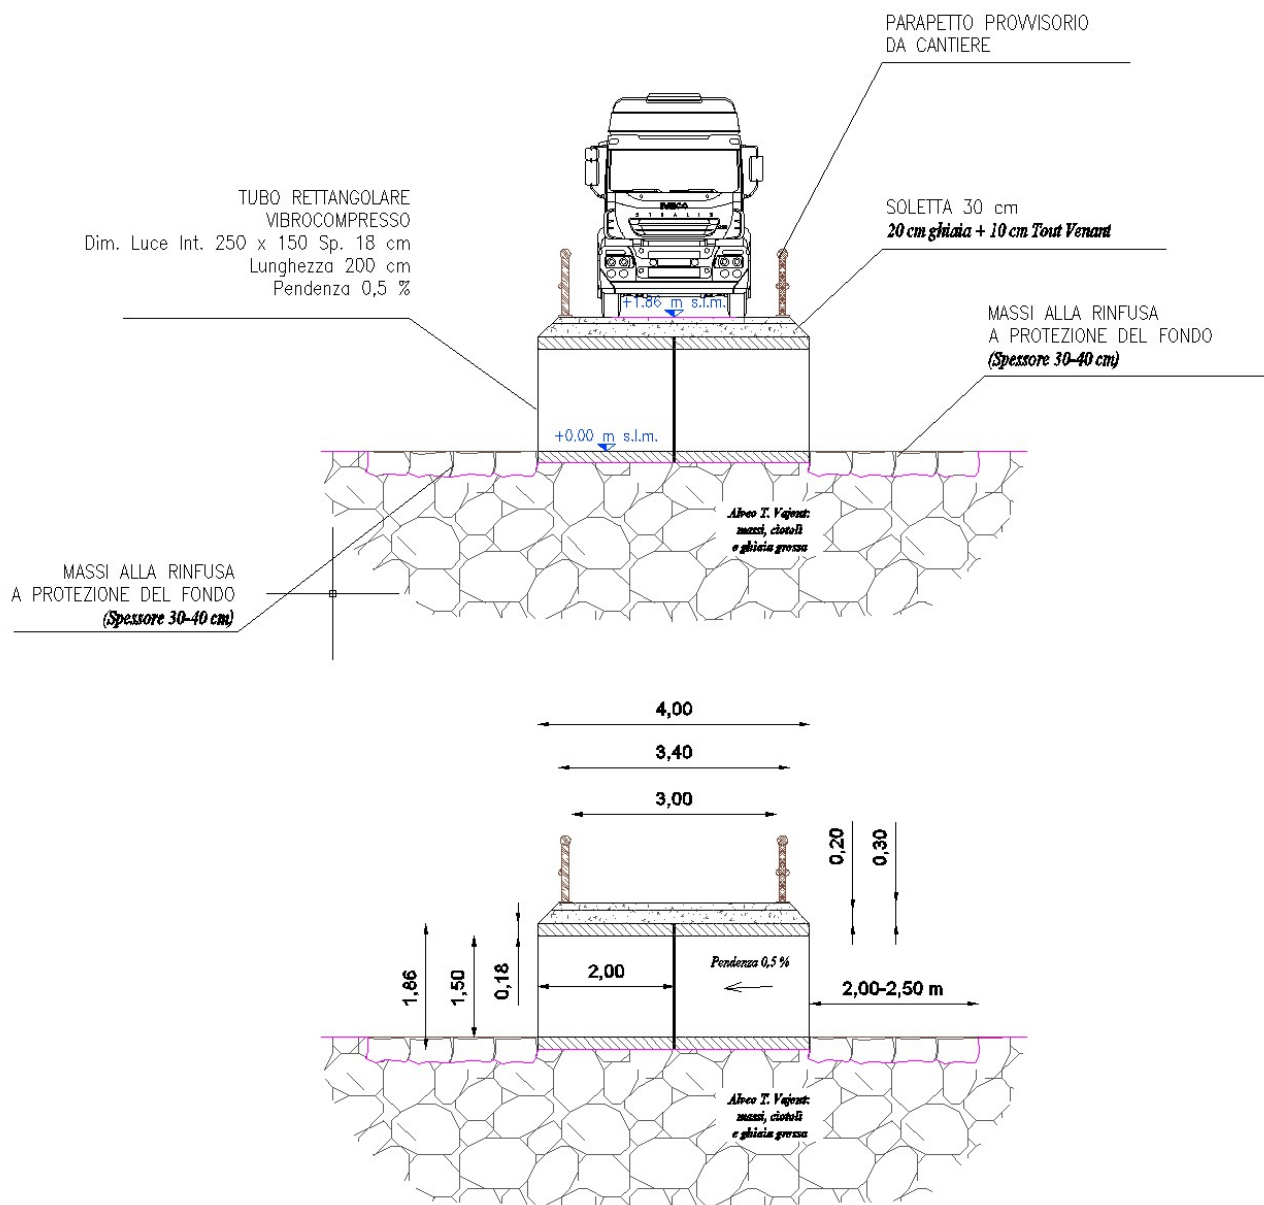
Sezione trasversale dei guadi – attraversamenti fluviali.
